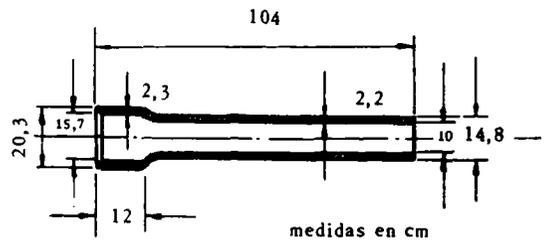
Tubo de hormigón simple para alcantarillado del tipo ensayado.
